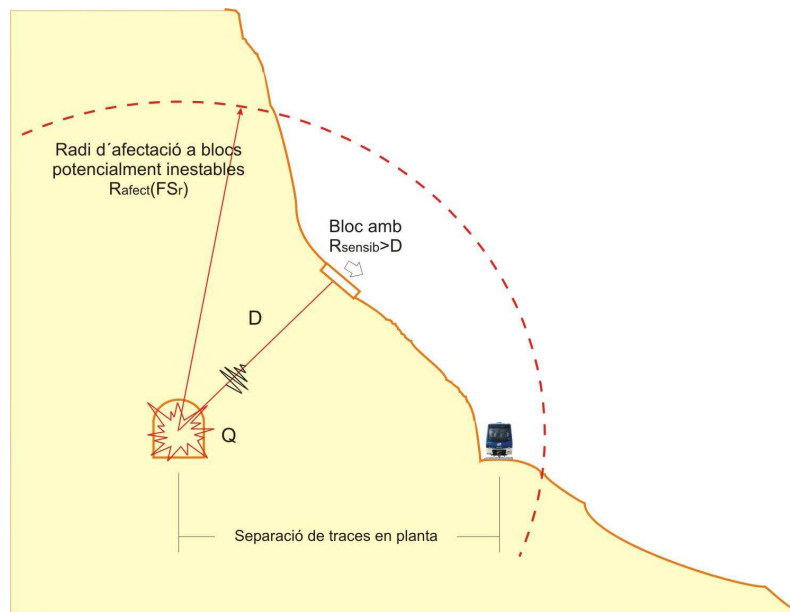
Esquema de la sección transversal de la transmisión de las vibraciones desde el túnel en excavación hasta superficie donde se encuentran los bloques potencialmente inestables.
